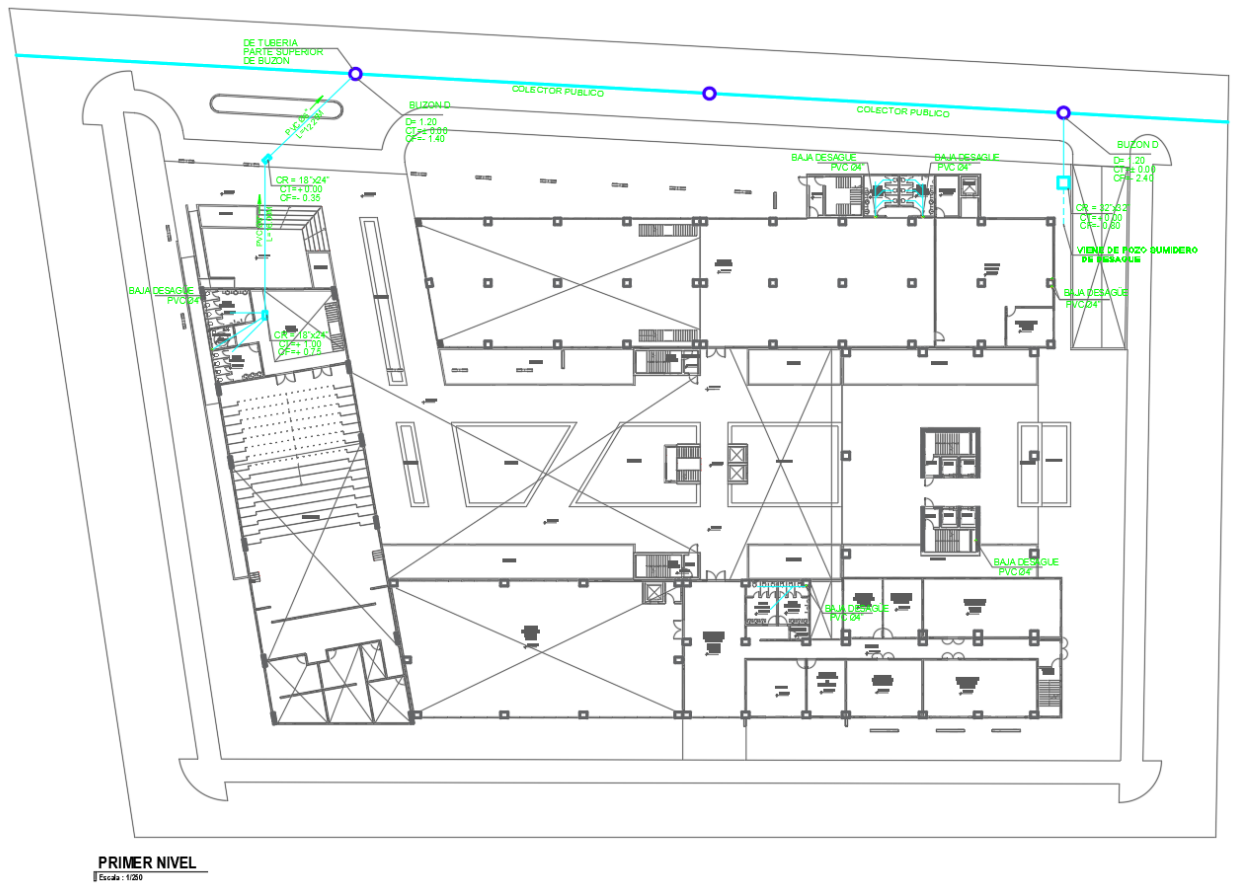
Plano primer nivel, desagüe. Fuente: Elaboración propia.
